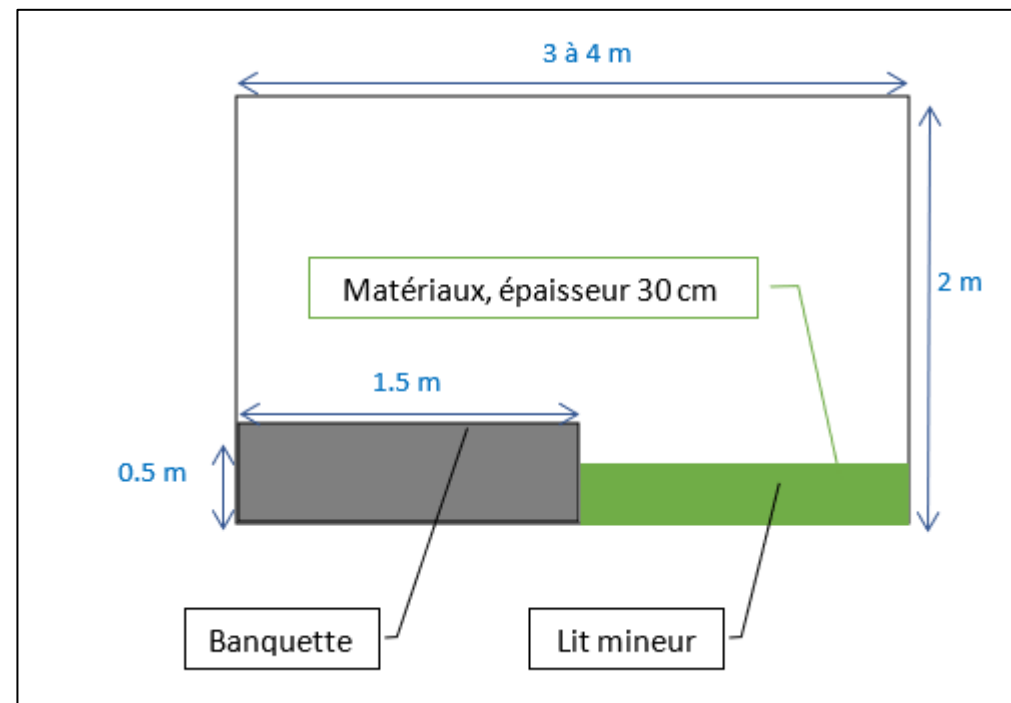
Schéma de l'ouvrage hydraulique sur le ruisseau de Plaisance
